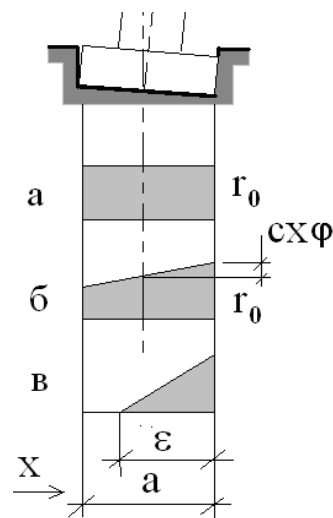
Расчетные схемы жесткого сооружения с фундаментом на упругом основании
